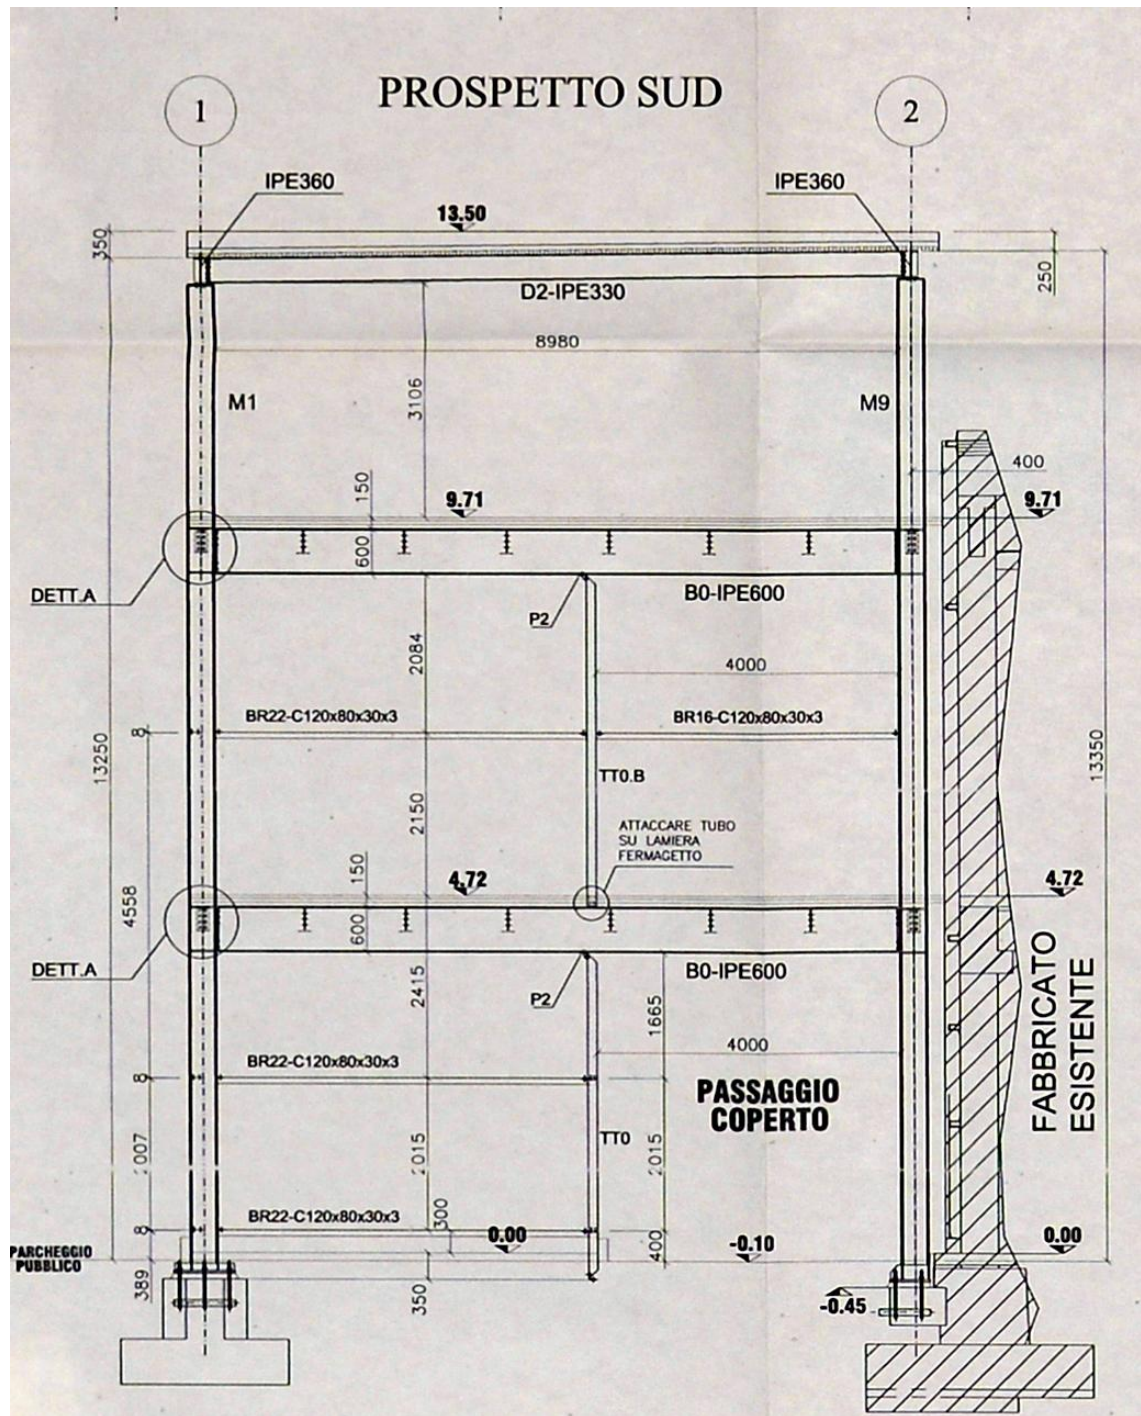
Particolare di A.2006.a.us.T05 - Prospetti e sezioni 2 - Prospetto Sud
